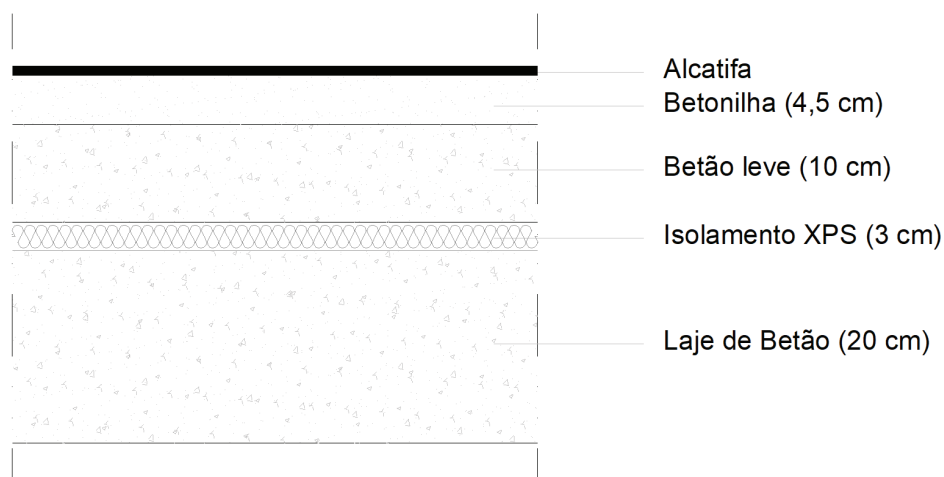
Pormenor construtivo do pavimento interior tipo IX (16.85-Receção, gabinete diretor, *open-space*, *conference room* e *florest*)
